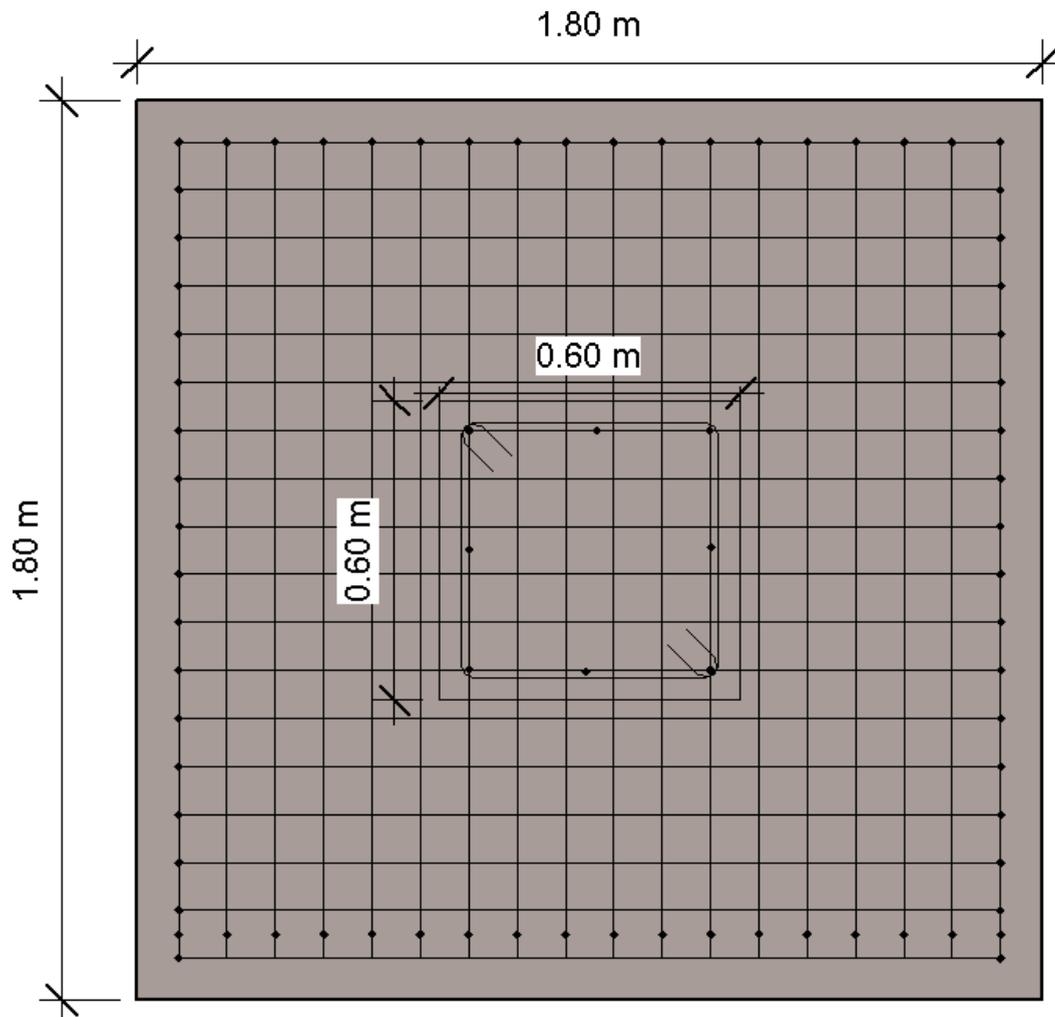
Zapata aislada cuadrada de cimentación (Tipo ZC-01)
